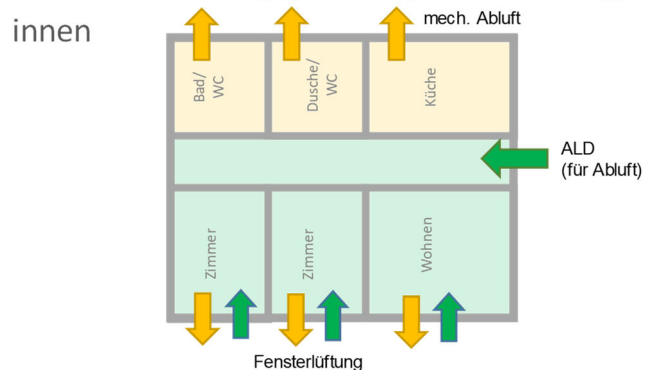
Funktionsschema und Wohnungsgrundriss / -schnitt vom LK4
